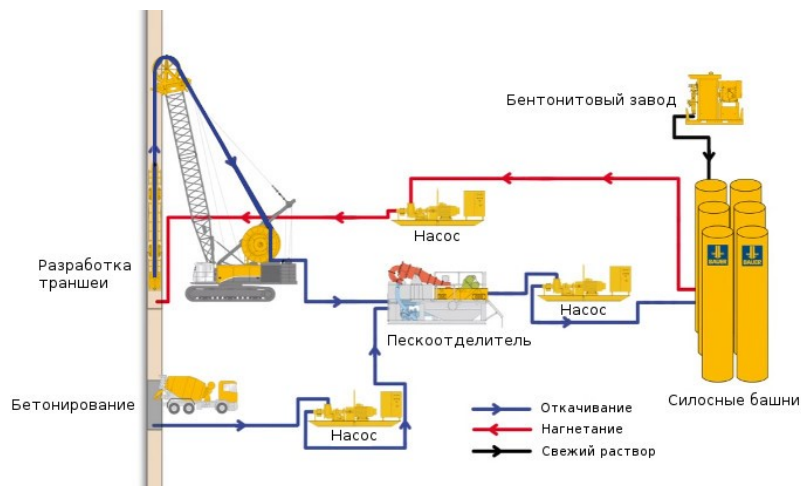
Схема оборудования Vaier для приготовления, нагнетания и откачивания бентонитового раствора при устройстве стены в грунте (<https://www.beststroy.biz/ru/stena-v-grunte>)
